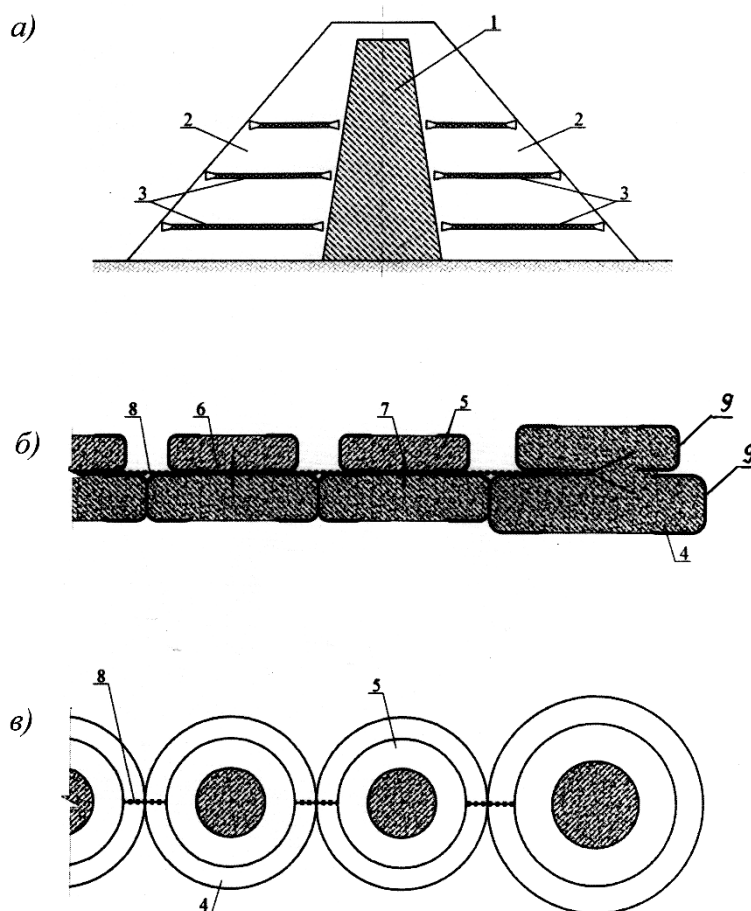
Плотина из местных грунтовых материалов с армирующими элементами:
